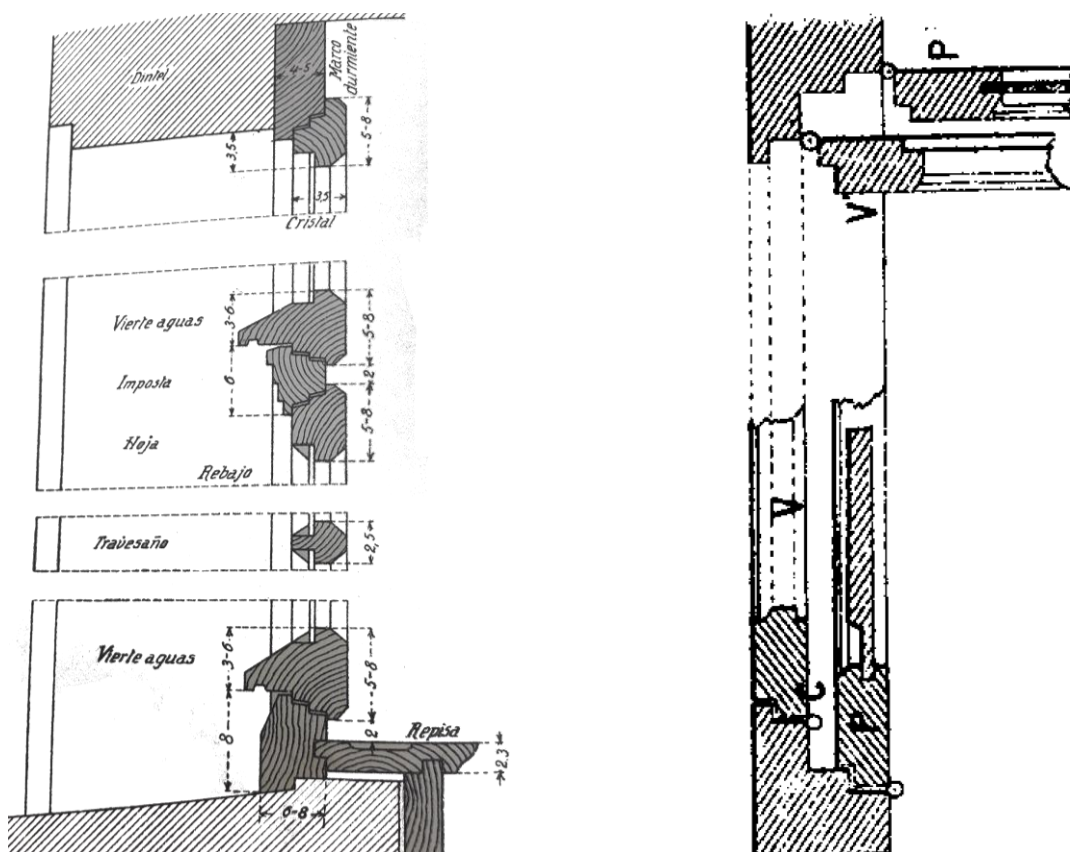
(izq.): sección vertical carpintería de madera. Fuente: Esselborn, 1940.
